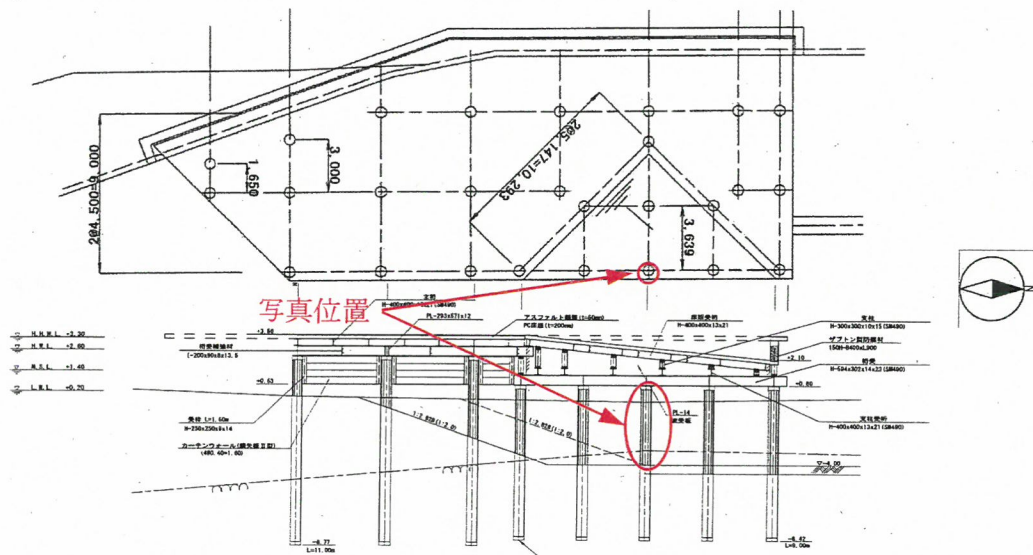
搬出入施設・車両乗降部 平面・横断面図 (下部工：海水面より下)
